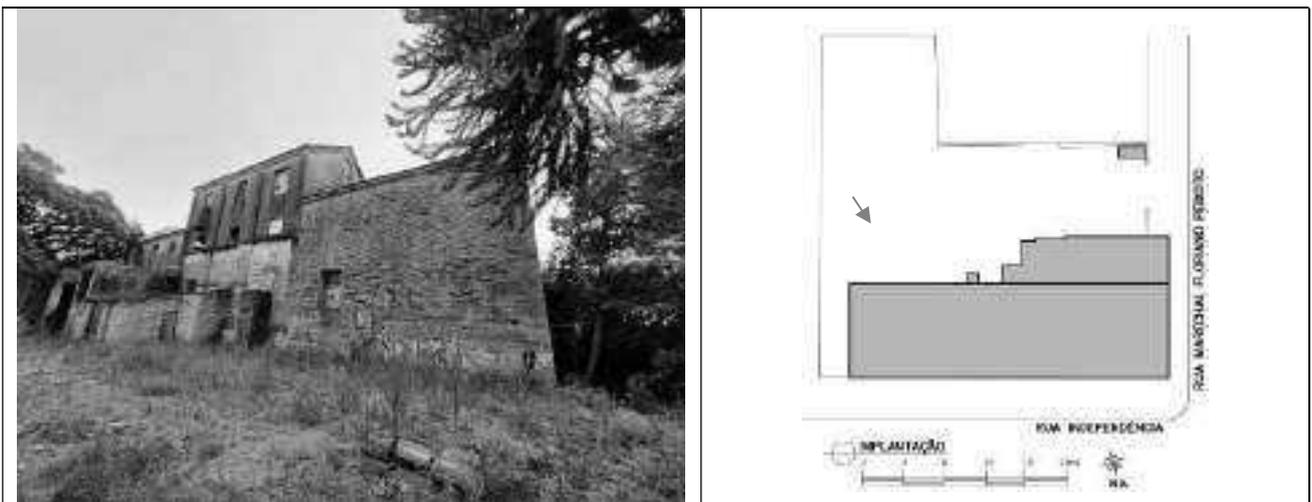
Fachada Principal – Rua Independência – o módulo Leste, em primeiro plano, foi edificado em 1942 para abrigar áreas de armazenagem de grãos. Fonte: ASSIS, Adriana Paiva de. 11/01/2024.
